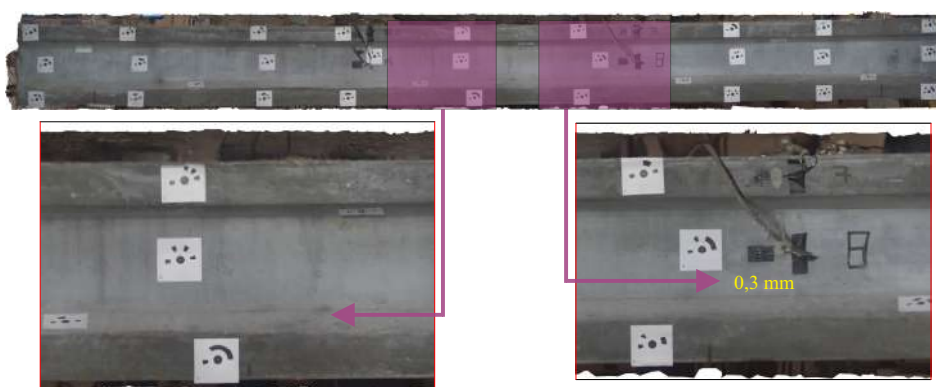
Fissuração máxima no 2<sup>o</sup> Ciclo - Viga UHPFRC protendida (V02)
